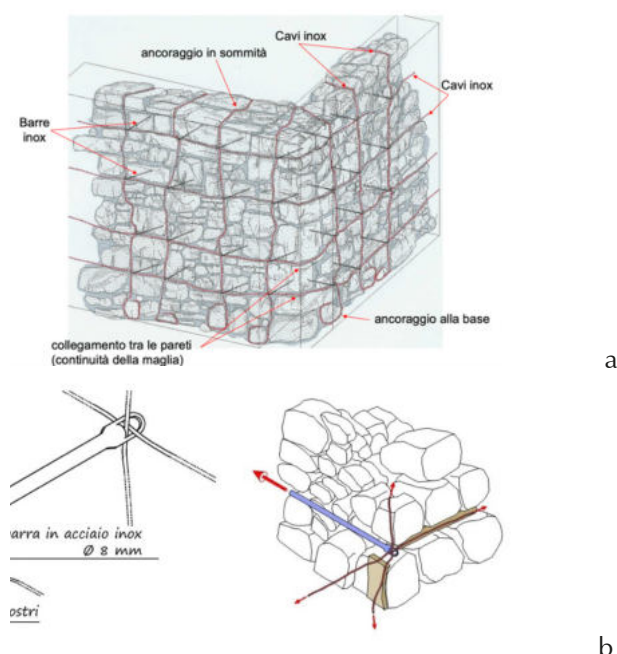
Schematizzazione del rinforzo con "Reticolatus" su entrambe le facce della muratura (a) e particolare del connettore trasversale di collegamento tra la maglia e la muratura (b).
